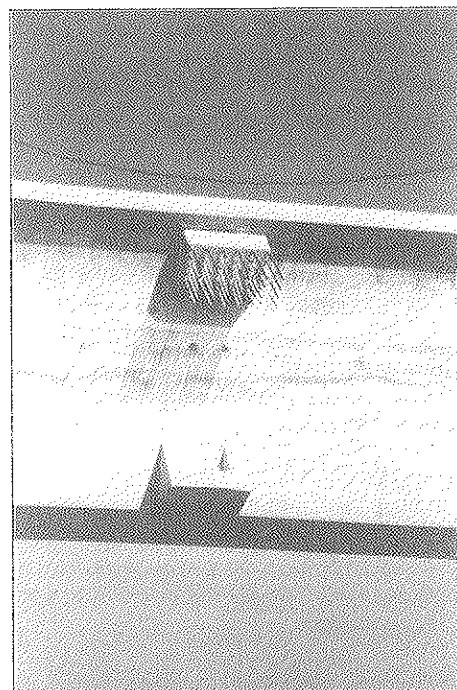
Cajón de hormigón con anclajes para tablero lateral.
